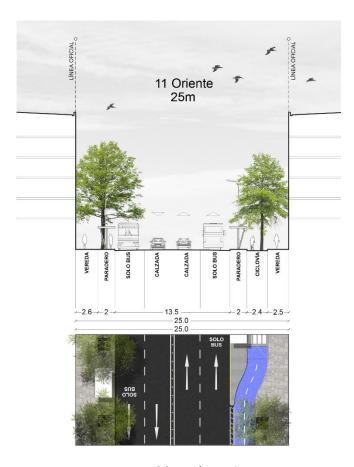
Perfil existente y propuesto Av. 11 Oriente (Entre 4 y 2 Norte)
